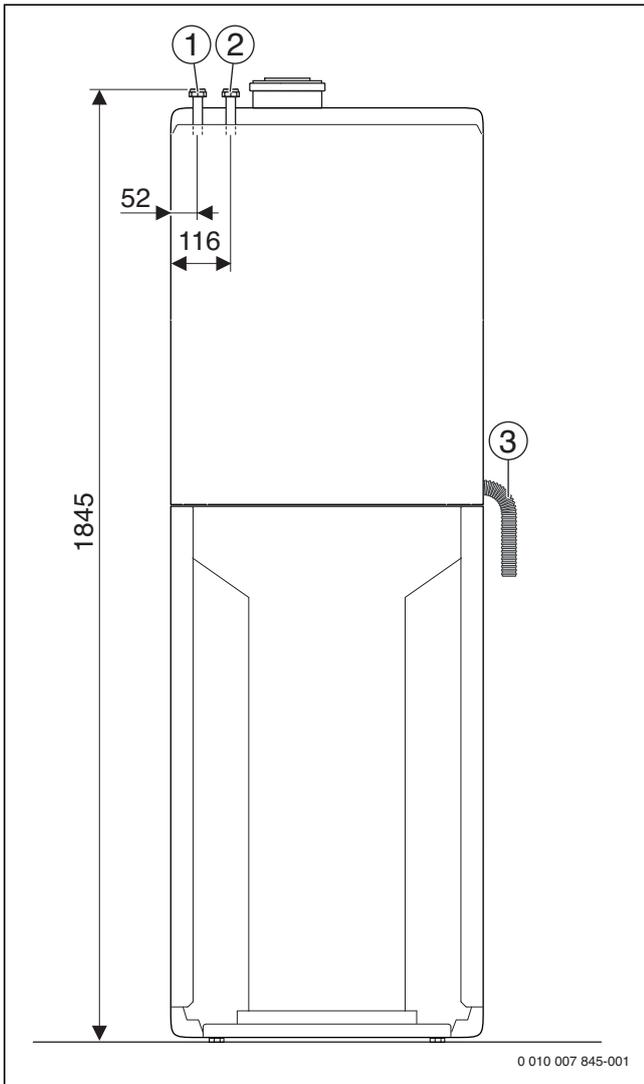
Anschlussmaße des Zubehörs CS 14 (Maße in mm)
